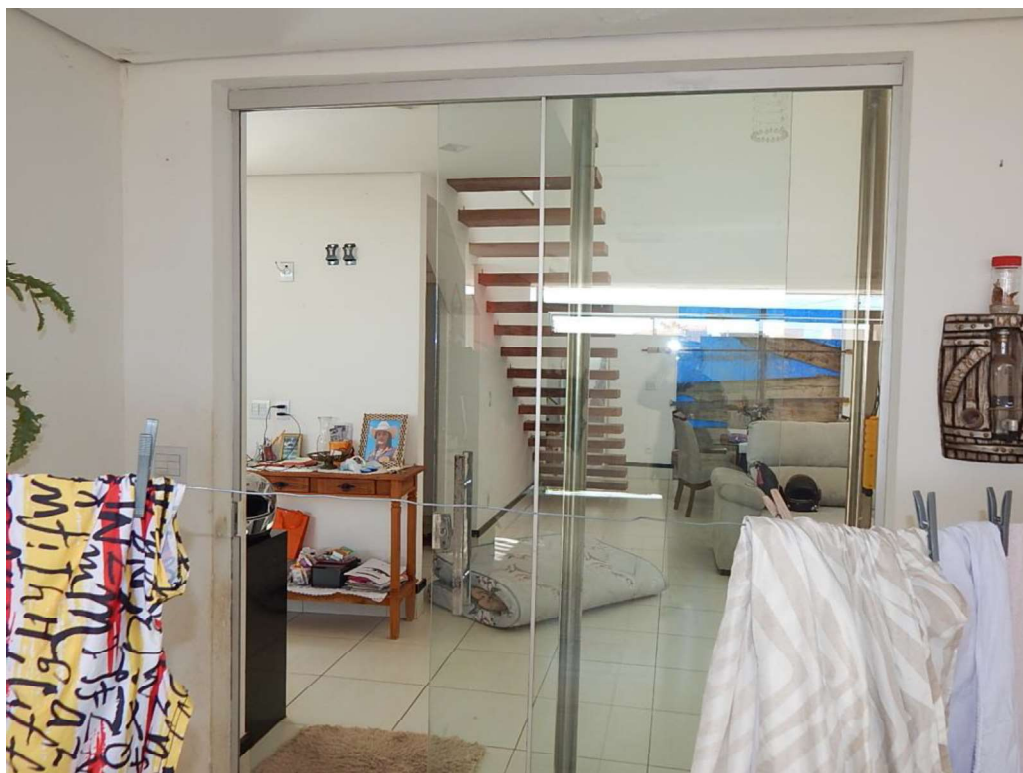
PORTA DE VIDRO COM ACESSO ÀS SALAS
